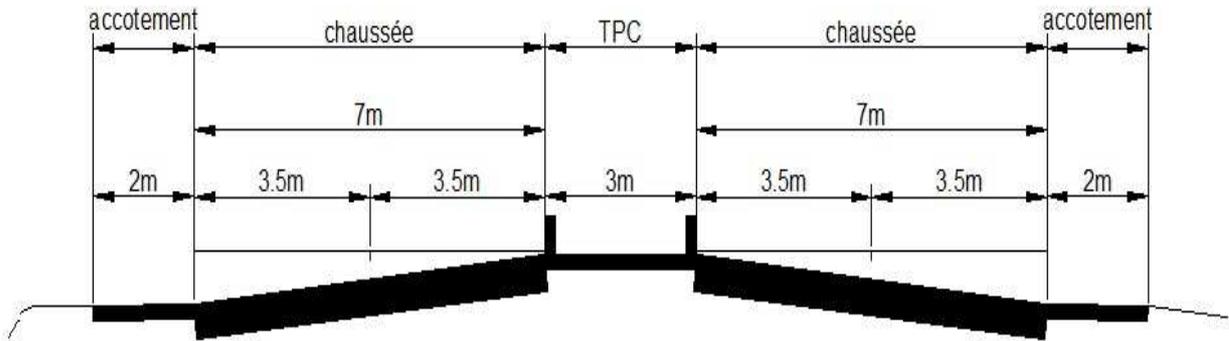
Schéma explicatif d'une Coupe transversale de la chaussée
